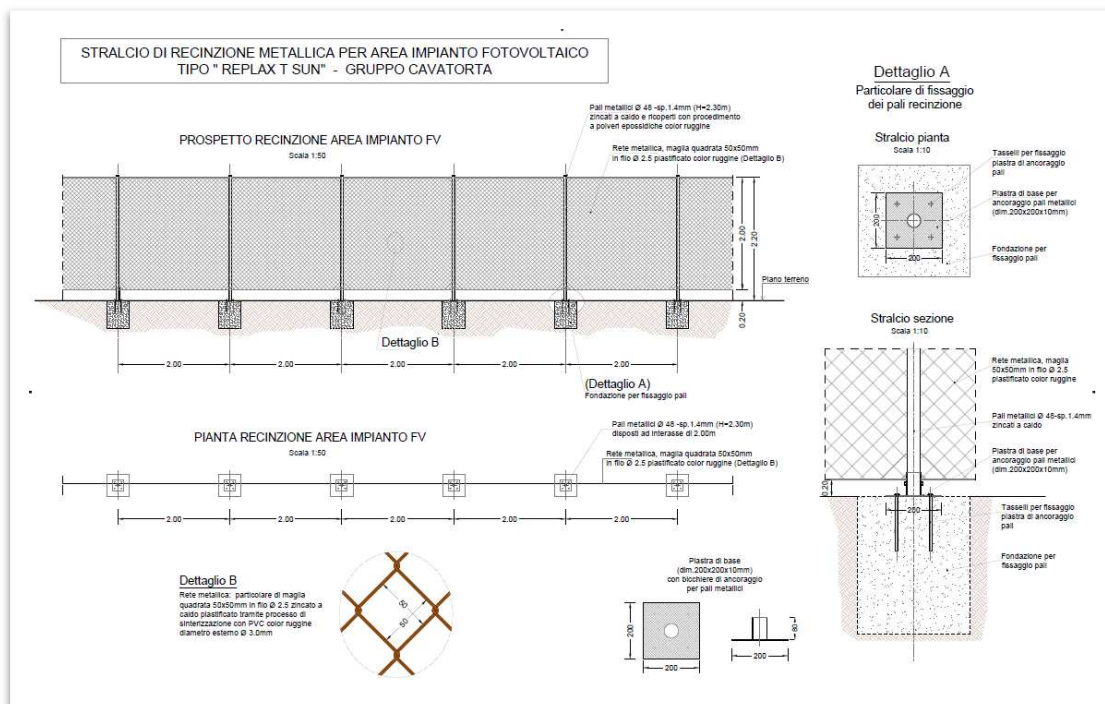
Pianta e sezioni delle opere di recinzione dell’impianto
